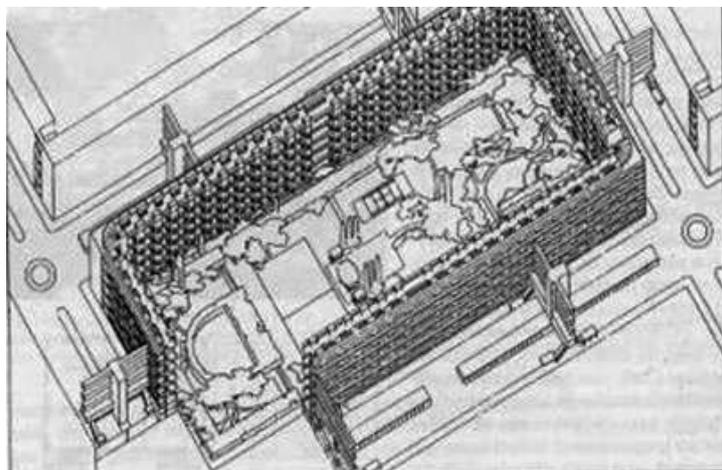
Complexo das Immeubles-Villas e suas ligações a outros conjuntos urbanos
